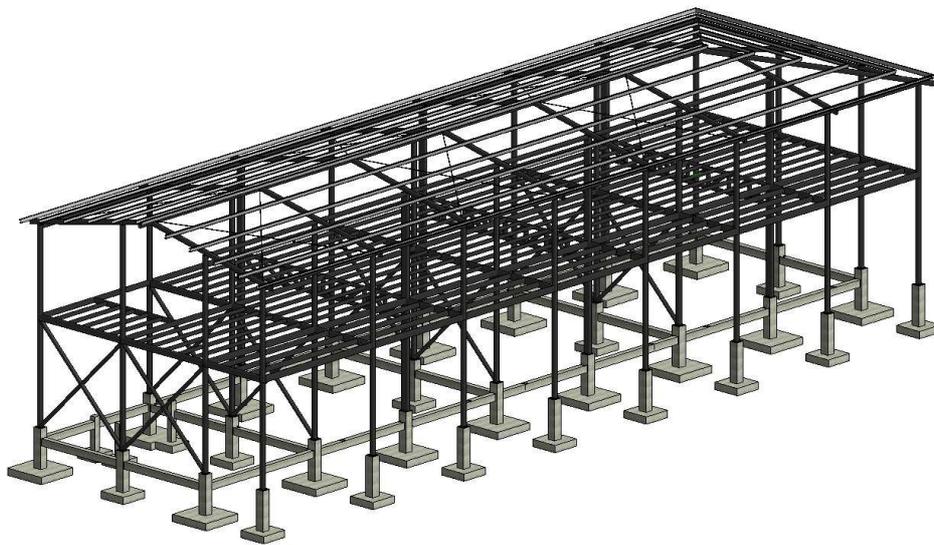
Estructura metálica del edificio 01, fuente: elaboración propia.
